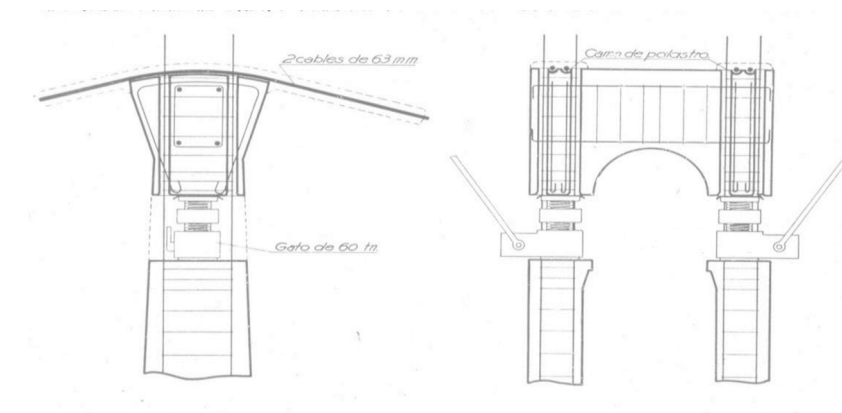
Dispositivos de elevación de las cabezas de los pilares.
